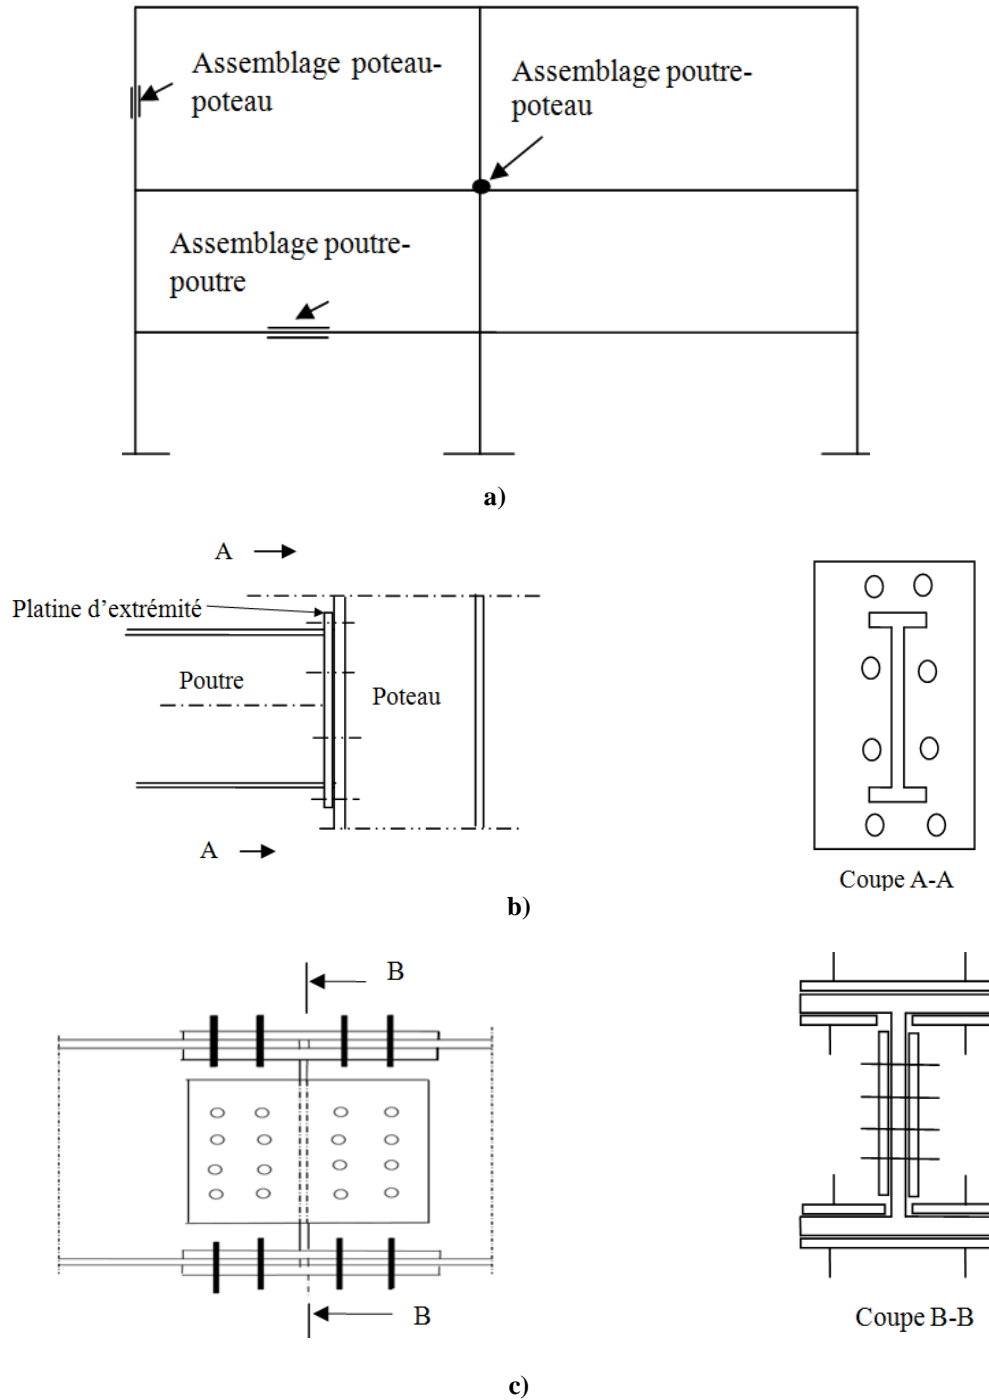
Assemblage par boulons à serrage contrôlé ; a) portique autostable, b) Assemblage poutre- poteau, c) Assemblage poutre- poutre ou poteau- poteau
